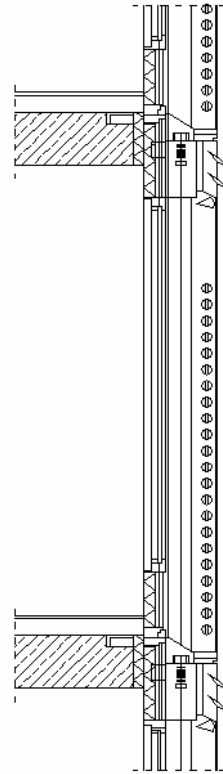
Fassadendetail und –innenansicht von Objekt 4
